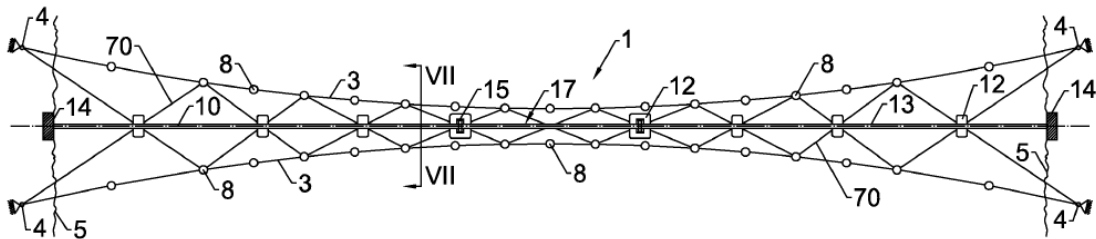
Grundriss, Variante 1c (Kollegger, et al., 2015)
